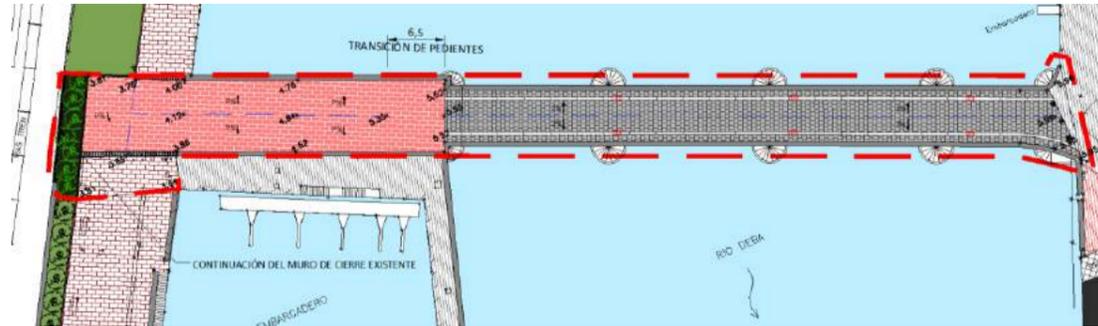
Planta tomada de los planos del presente proyecto donde se muestra el límite de actuación
